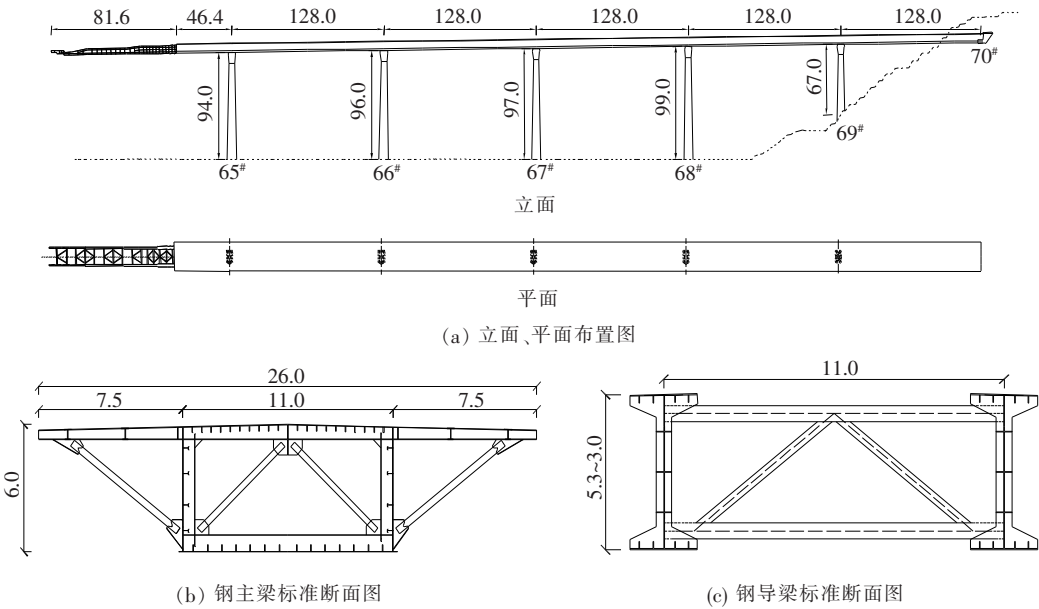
临猗黄河大桥施工期总体布置及钢箱梁、钢导梁断面图(单位:m)
